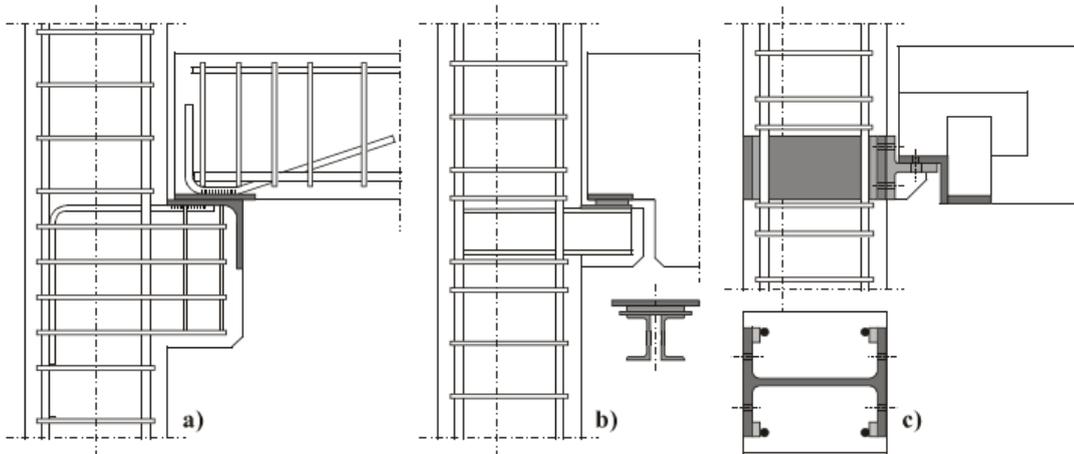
Conexión soporte-viga, unión metálica. Fuente: E. Barberá (s.f).
